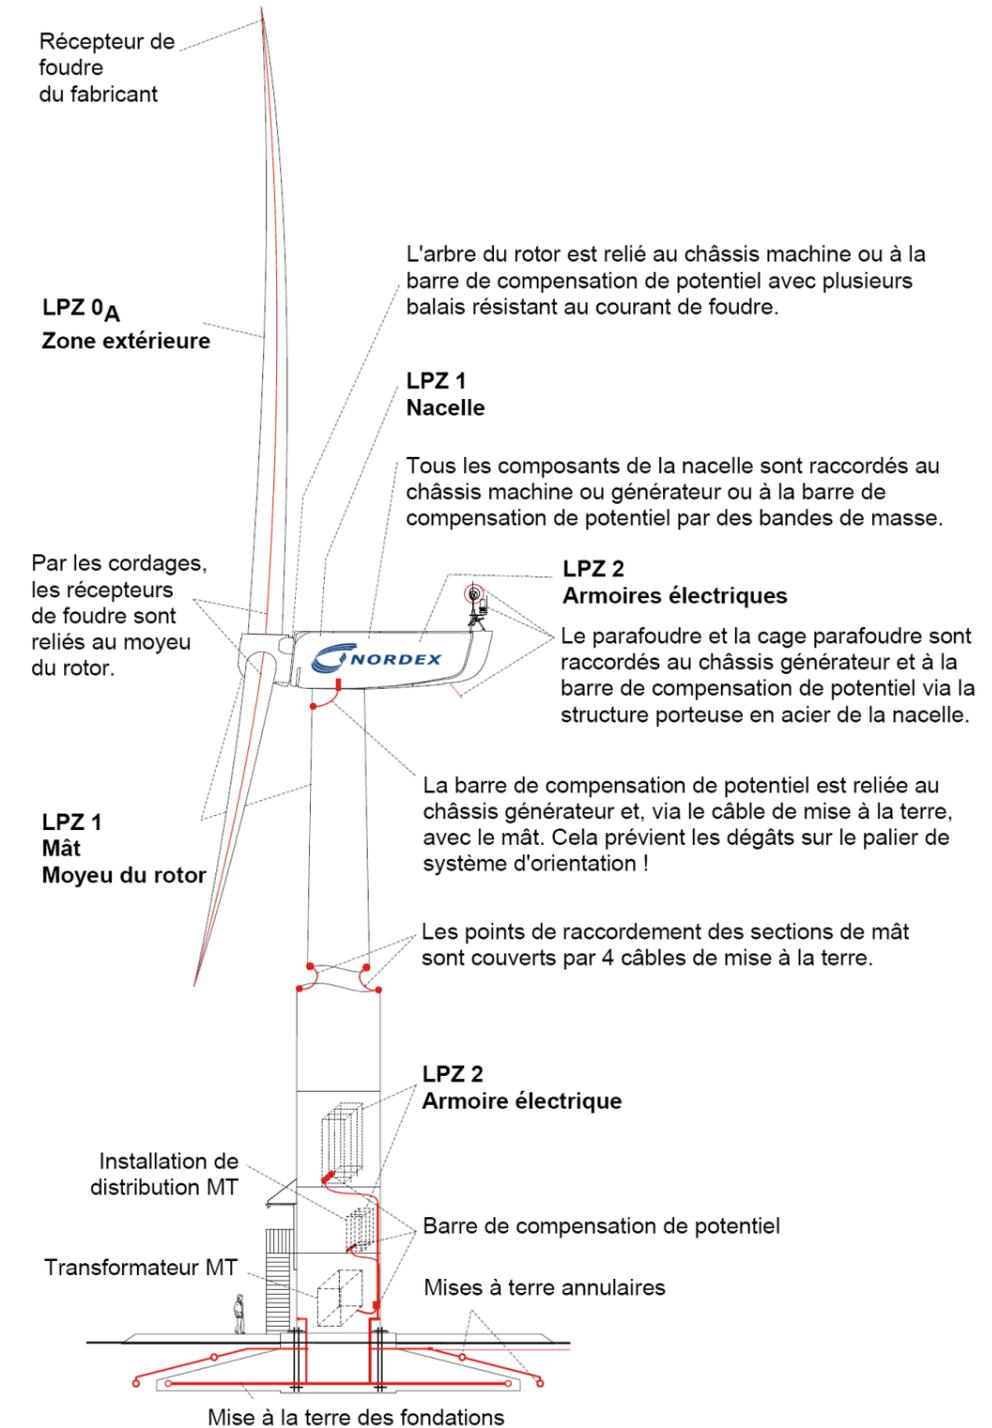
Dessin de vue d'ensemble des dispositifs de protection parafoudre dans l'éolienne (source : NORDEX)
